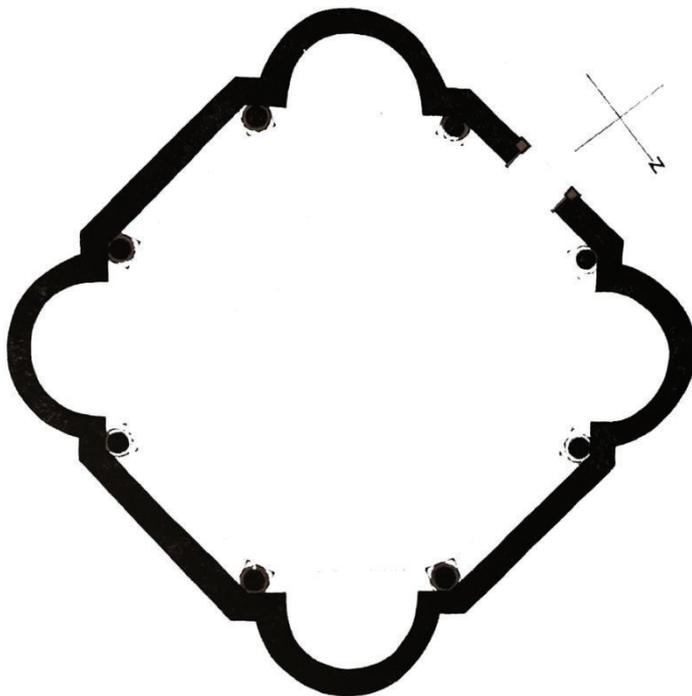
Planta del Baptisterio de los Ortodoxos.
